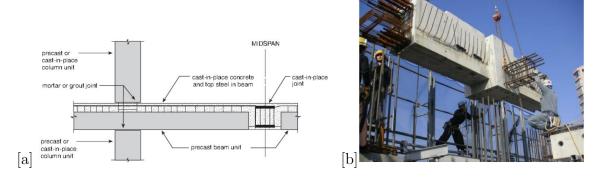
[a] Conexión viga prefabricada entre columnas in-situ. Fuente: (Aguirre, 2021); [b] Ejemplo real. Fuente: (Bedriñana, 2021)
